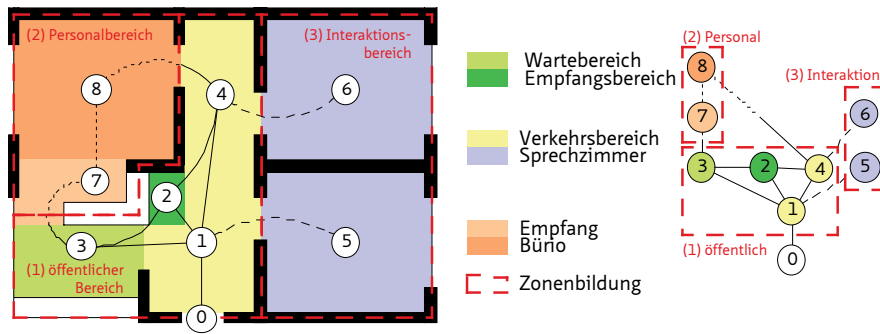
Funktionale Grundrissanalyse (links) und räumliche Konfiguration (rechts). Die funktionale Grundrissanalyse gibt einen Anhaltspunkt über die Nutzung der Bereiche mit unterschiedlichen Farben. In der räumlichen Konfiguration werden alle Bereiche als Kreise, die durch Linien verbunden sind, dargestellt. Die Zonenbildung im Sinne von öffentlichen (1), Personal- (2) und Interaktions- (3) Bereichen wird ebenfalls sichtbar gemacht.
